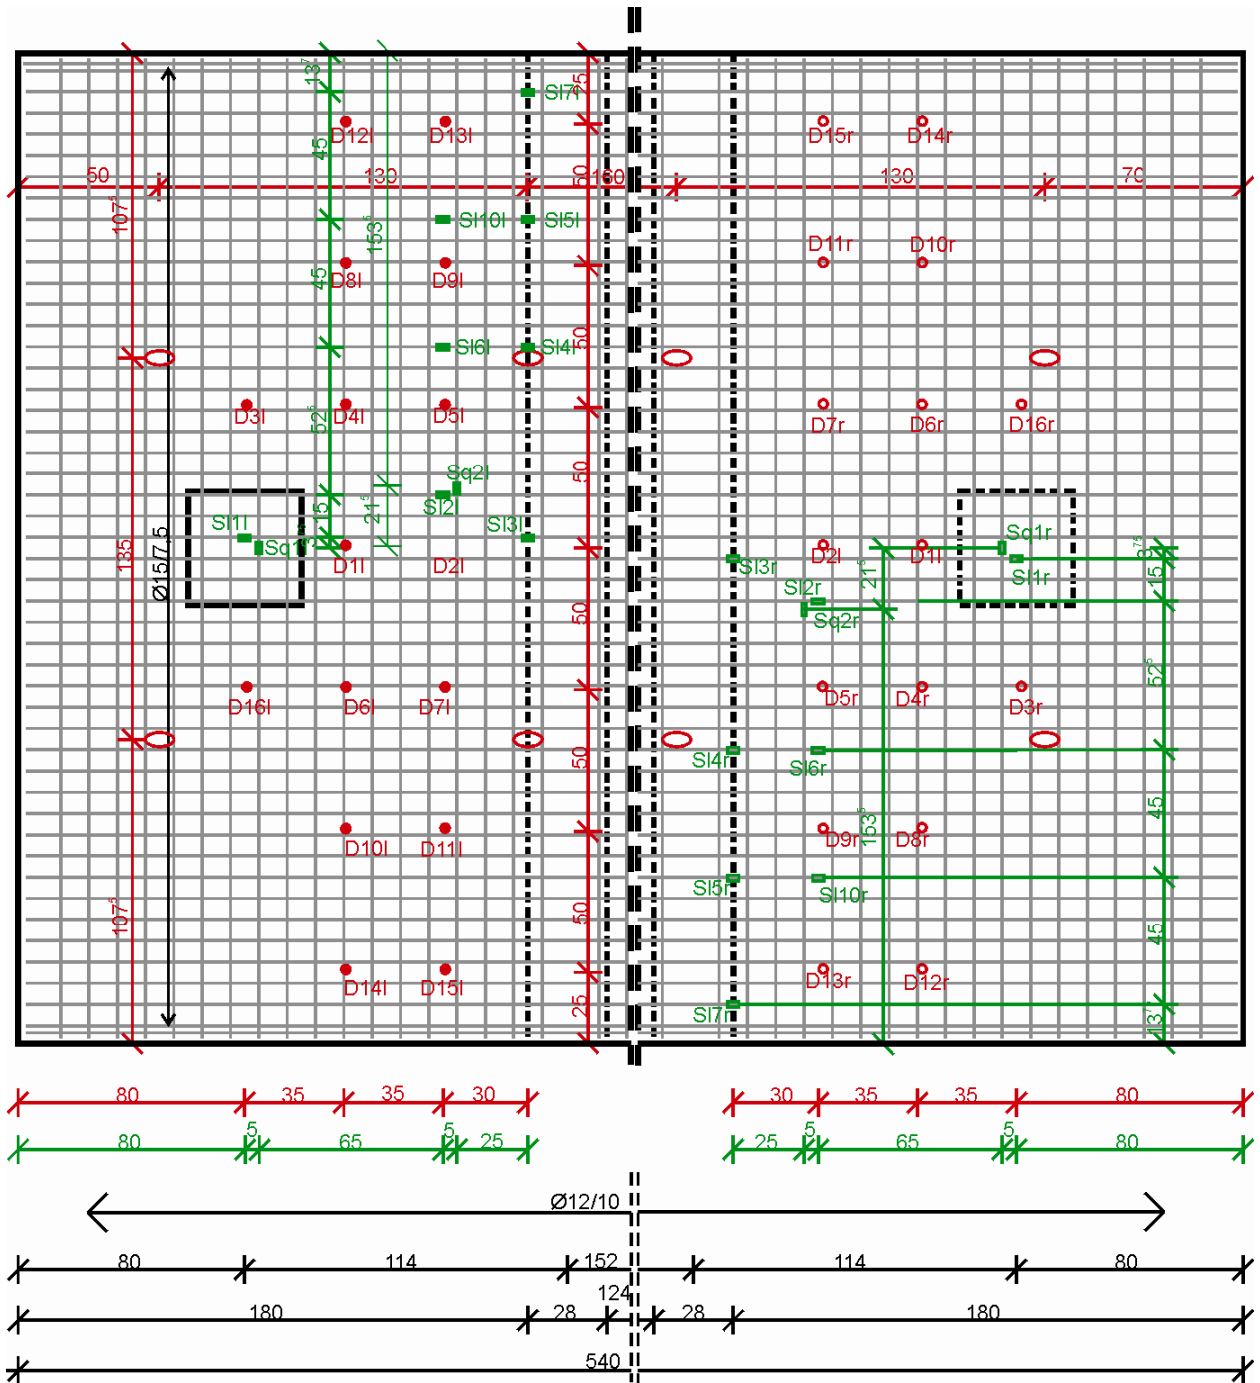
Messtechnikplan vor Betonage für die Versuchskörper SC35B und SP35B: Obere Bewehrungslage, Stahl-DMS, Dickenmessung und Lage der Transportanker
